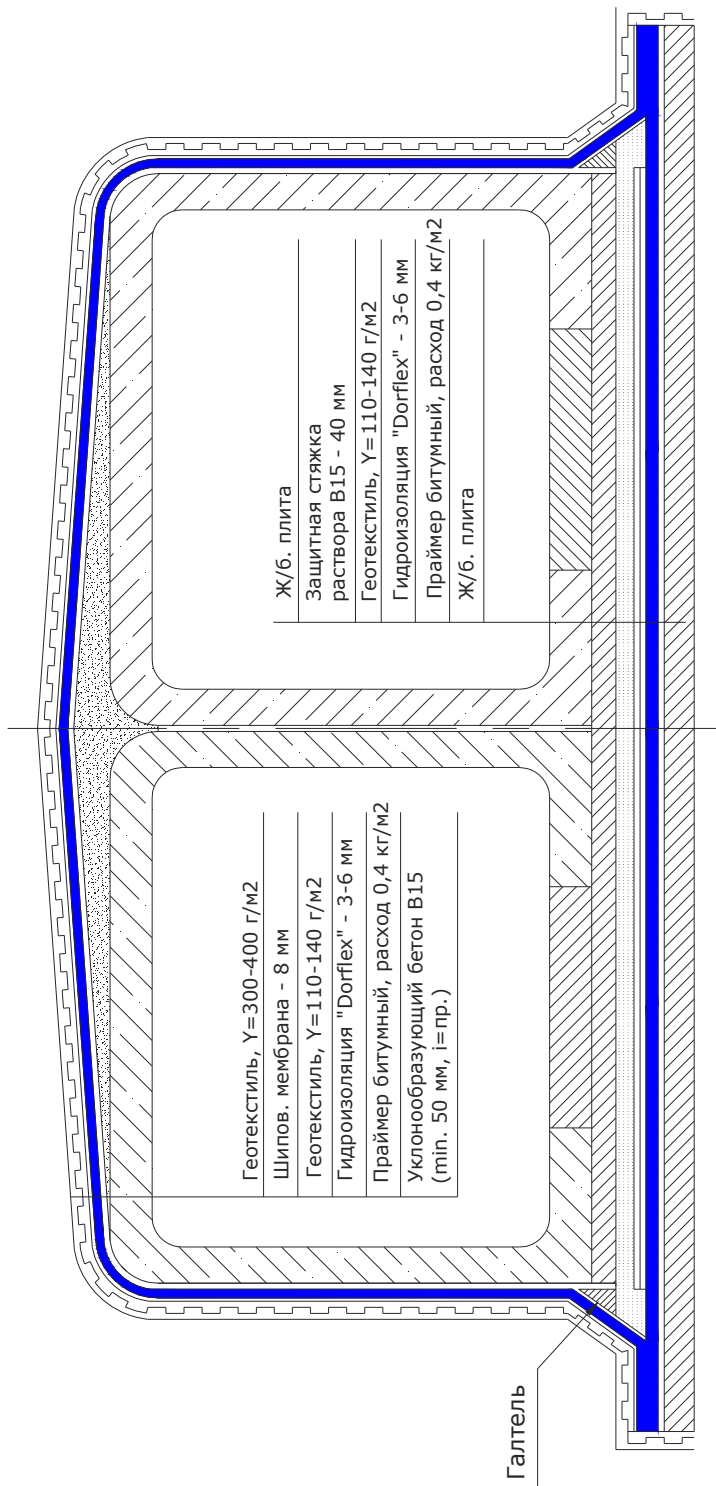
Гидроизоляционная мембрана без защитного слоя.
